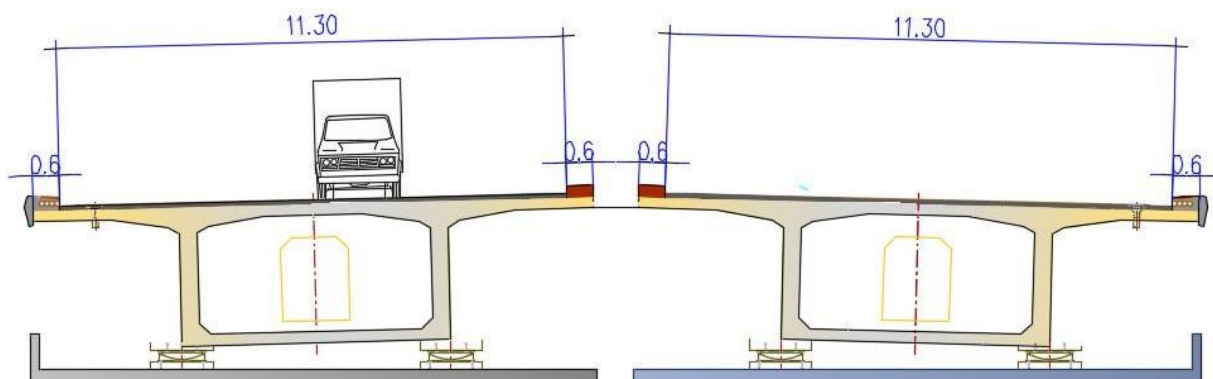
Coupe transversal en mis travée et au niveau de la pile.
